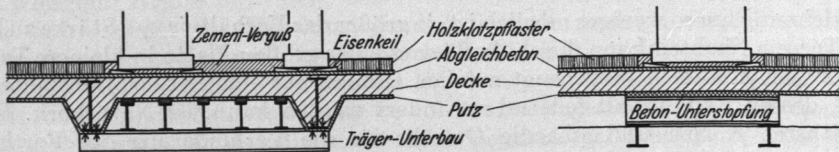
Verstärkung der Deckenplatte unter einer schweren Maschine.
